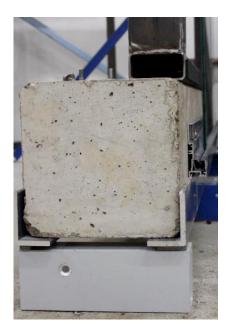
Versuchsaufbau, Betonklotz zur Befestigung der Profile (exemplarisch vorgesetzte Montage)
